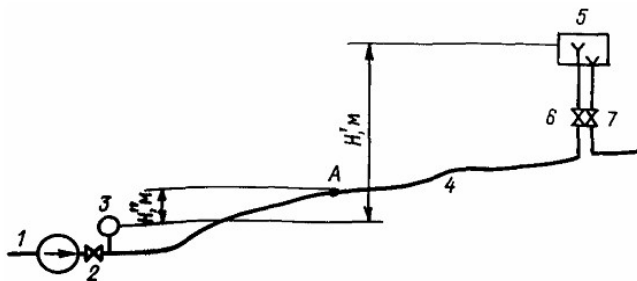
Схема определения утечки воды манометром, установленным на насосной станции:
